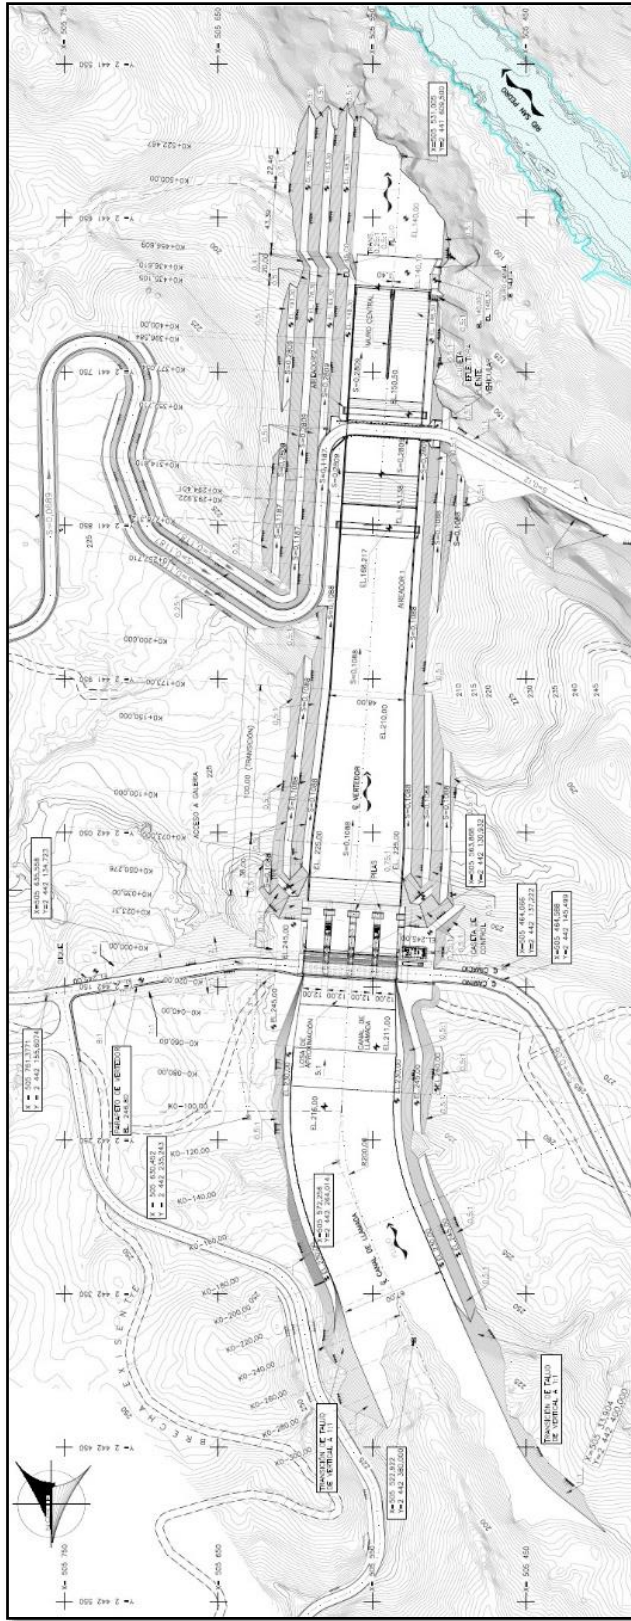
PLANTA GENERAL DE OBRA DE EXCEDENCIAS
